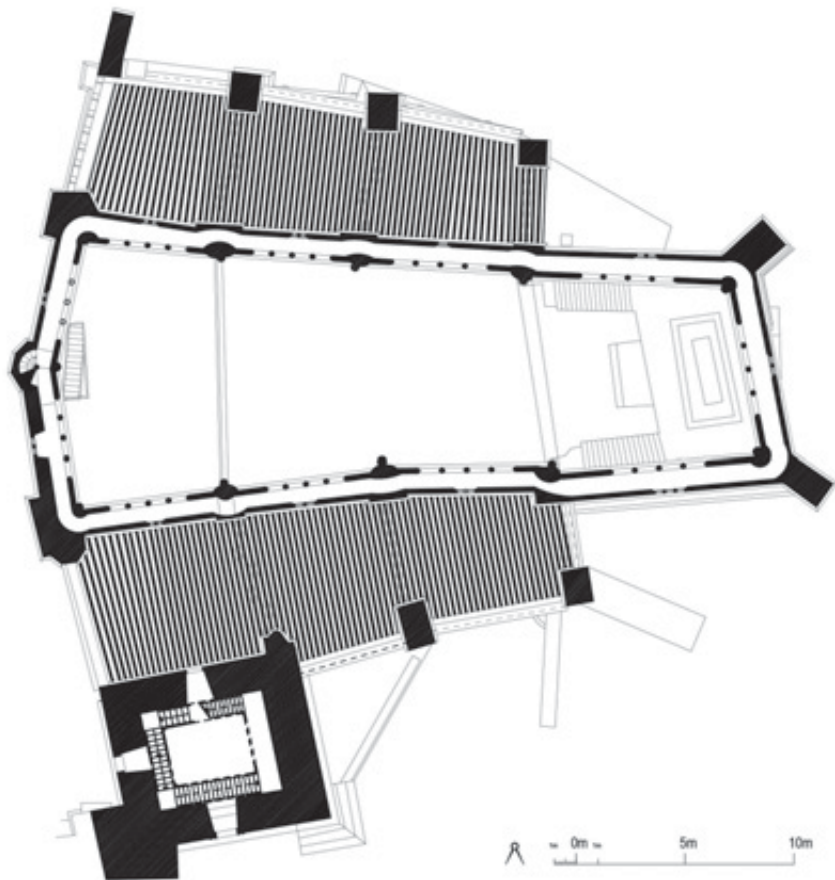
San Salvador de Getaria: Planta al nivel del claristorio. Dada la extrema esbeltez de los muros, las paredes apenas incorporan material resistente, excepto en la mitad meridional de la fachada occidental, rehecha por los prudentes cuidados de Tiburcio Spanochi.
